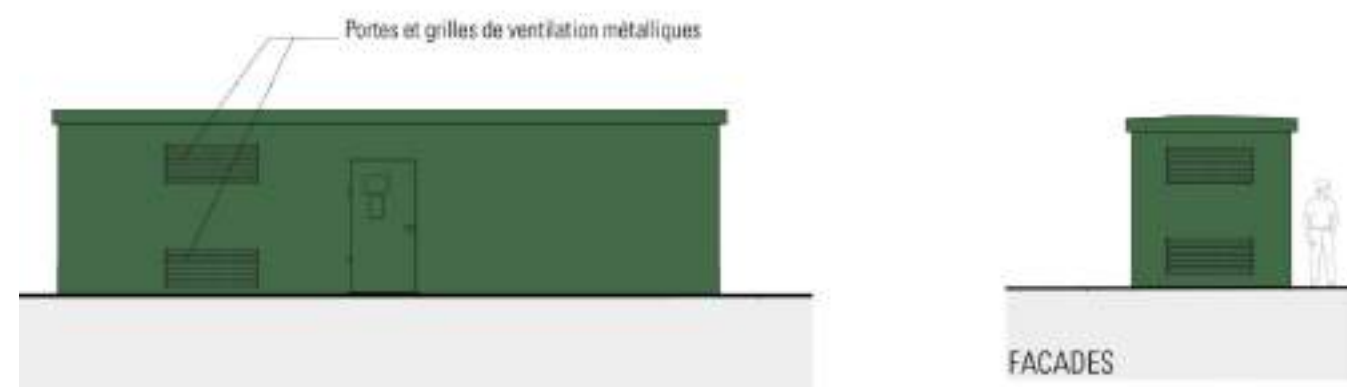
Vues des façades du poste de livraison prévu sur site
